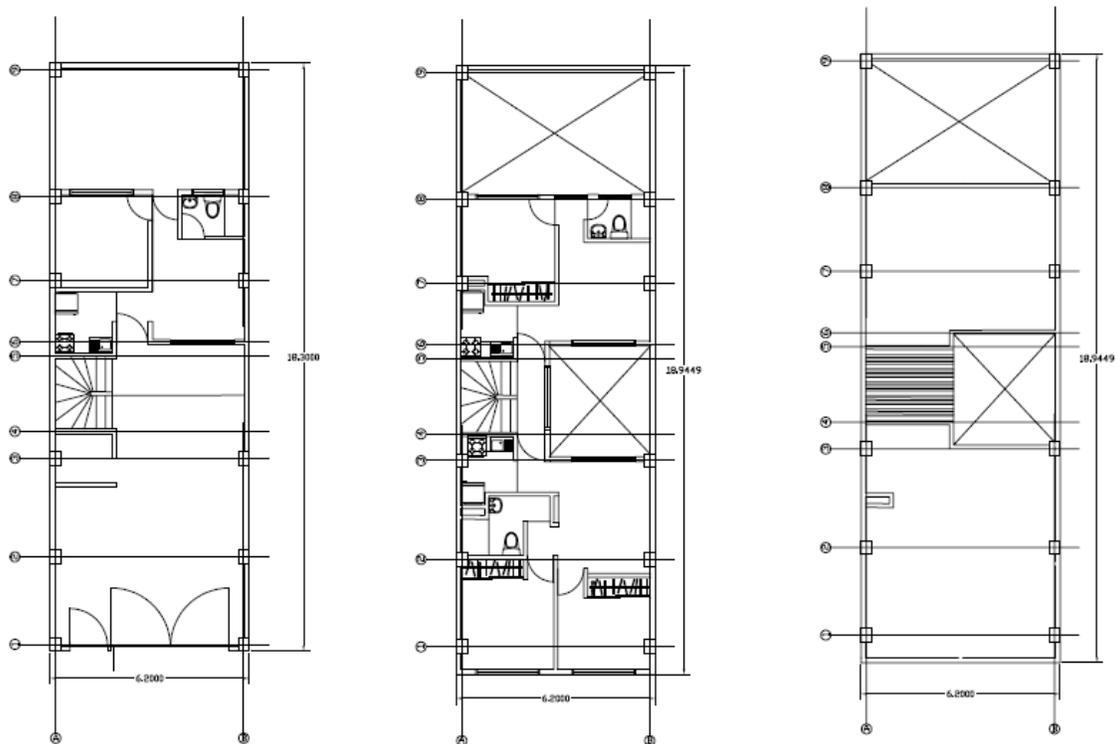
Planos arquitectónicos a) Planta primer piso. b) Planta tipo. c) Planta terraza. (Fuente Propia)
